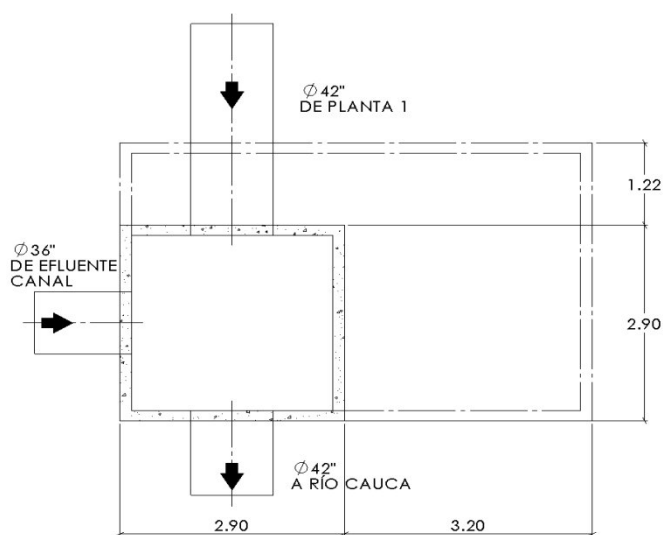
Dimensiones a extender para la Casa de Máquinas
